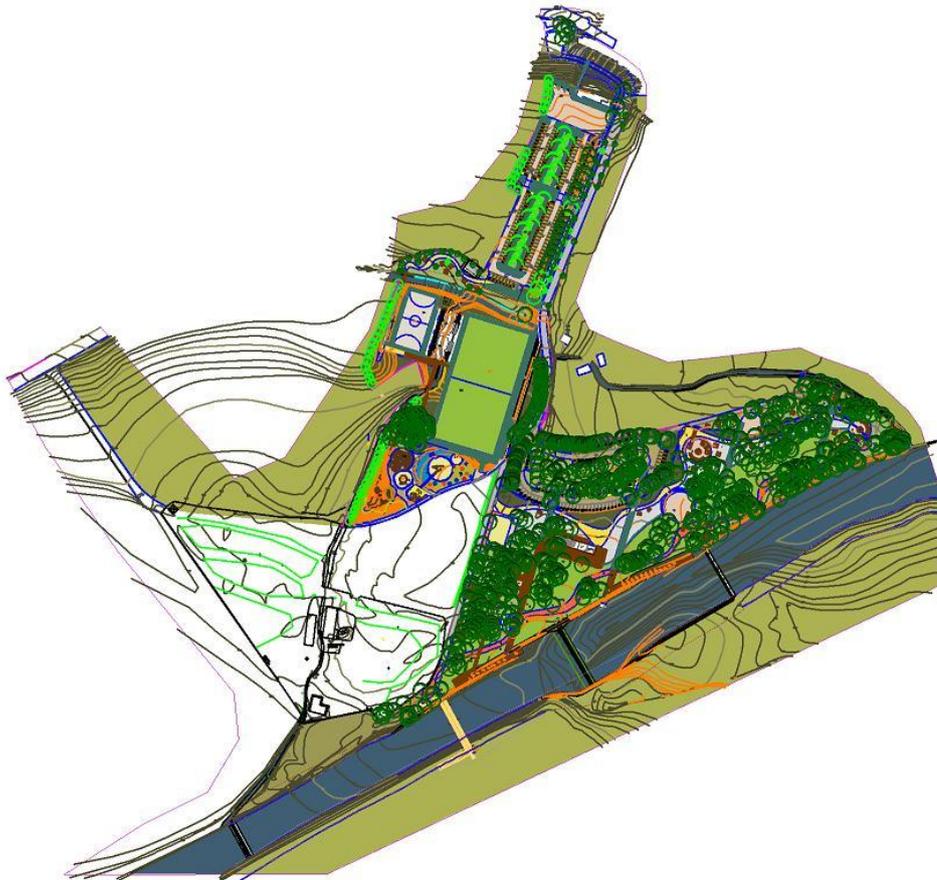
Plano Geral do Projecto de Valhelhas (sem escala)
